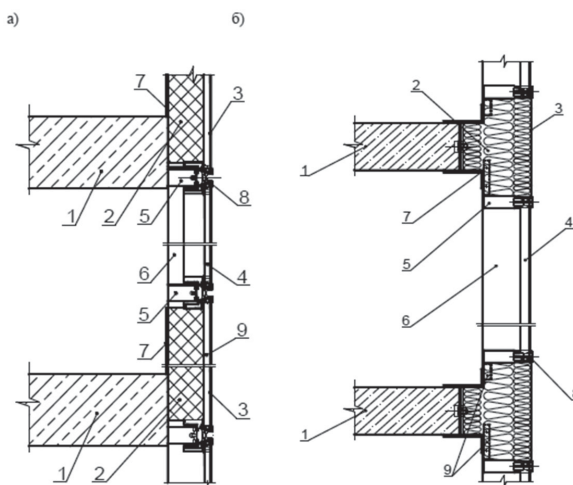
Конструктивна схема зовнішніх стін з комбінованим світлопрозорим фасадом (а) та з суцільним світлопрозорим фасадом з термоізоляцією плит перекриттів (б)
